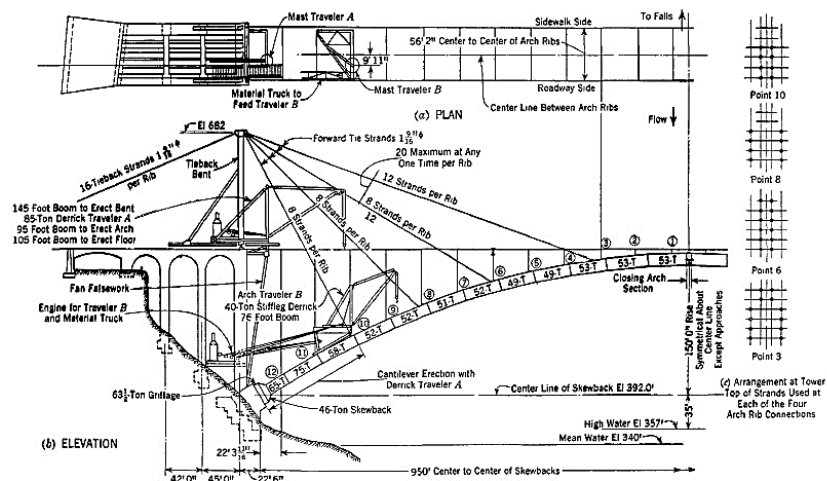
Esquema da construção do arco metálico da Rainbow Arch Bridge [6].
